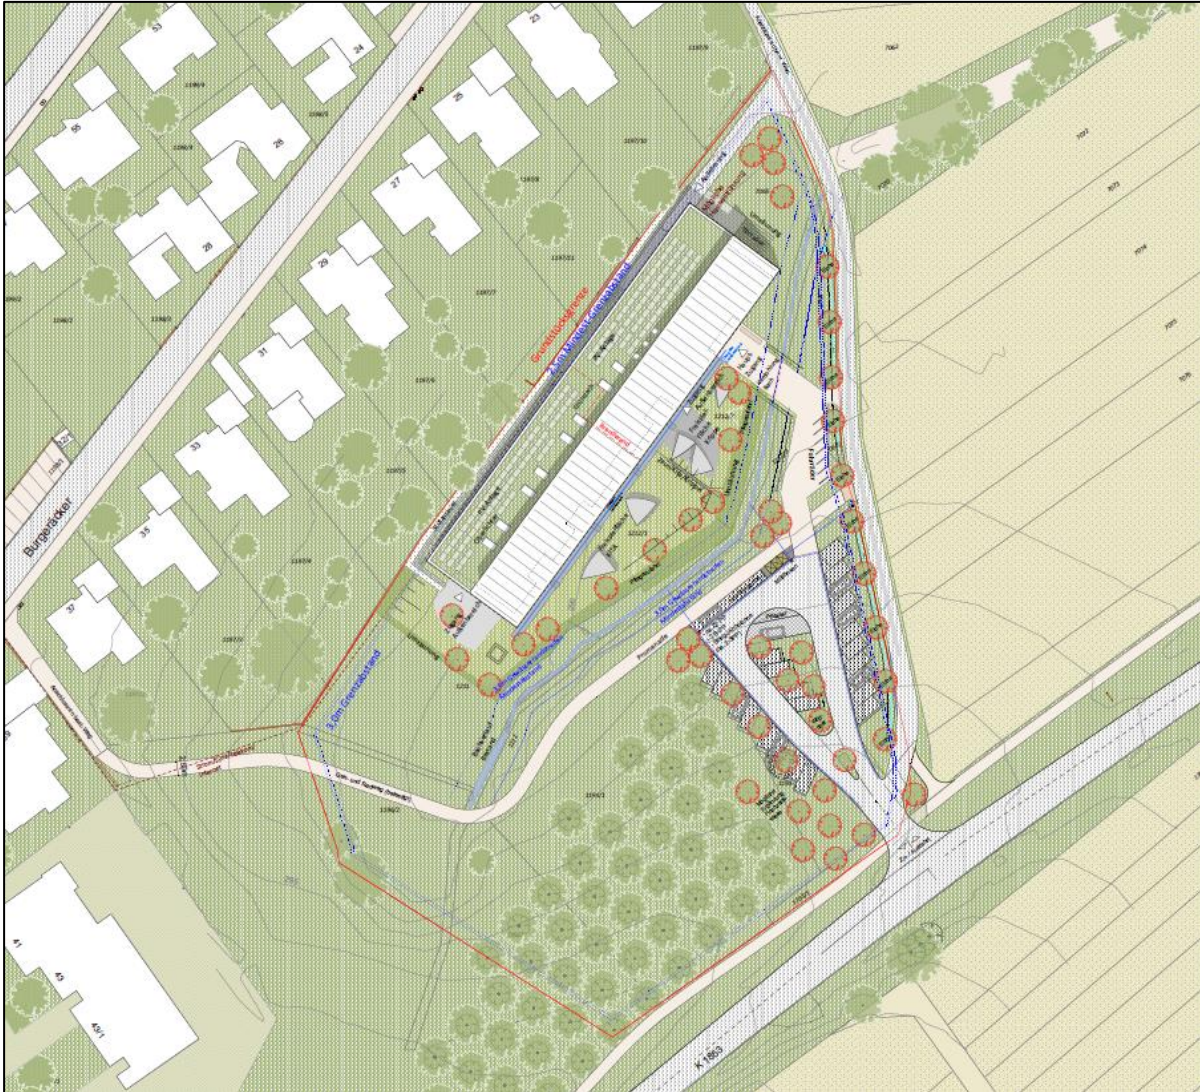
Vorentwurfsplanung LPH2 – Lageplan zum Bebauungsplan „Neubau Kindertagesstätte Koppelesbach“, Stadt Winnenden.
